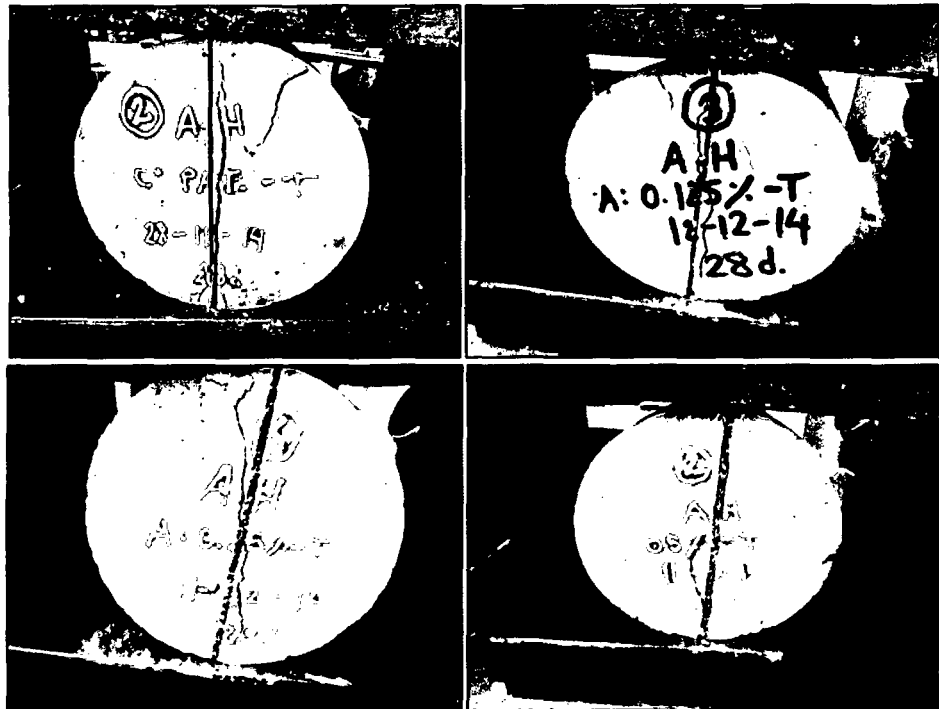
Fisuración de los especímenes de concreto cilíndricos ensayados a tracción indirecta.
